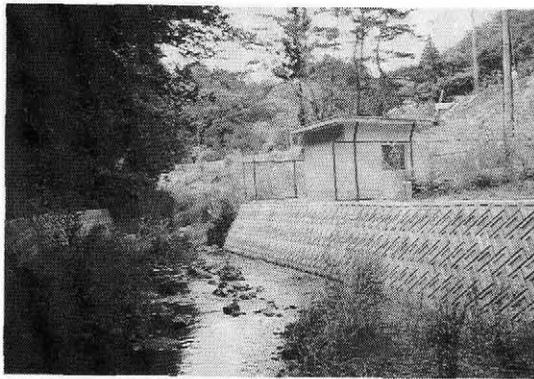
寺谷川右岸より取水 (建物 はポンプ場)
